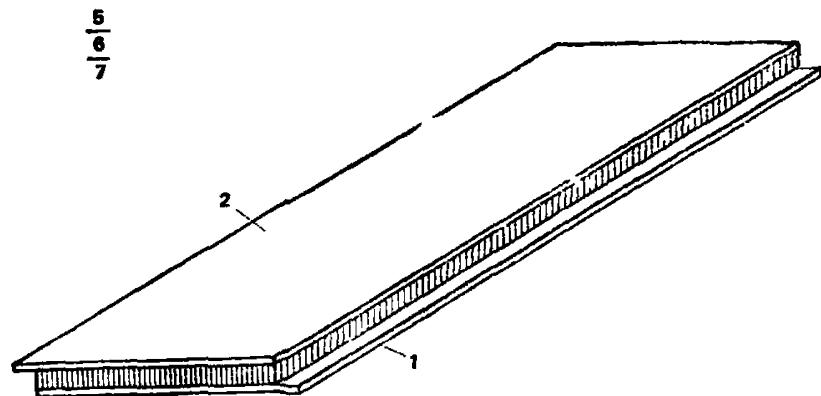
Трехслойные плоские плиты безрулонного покрытия
